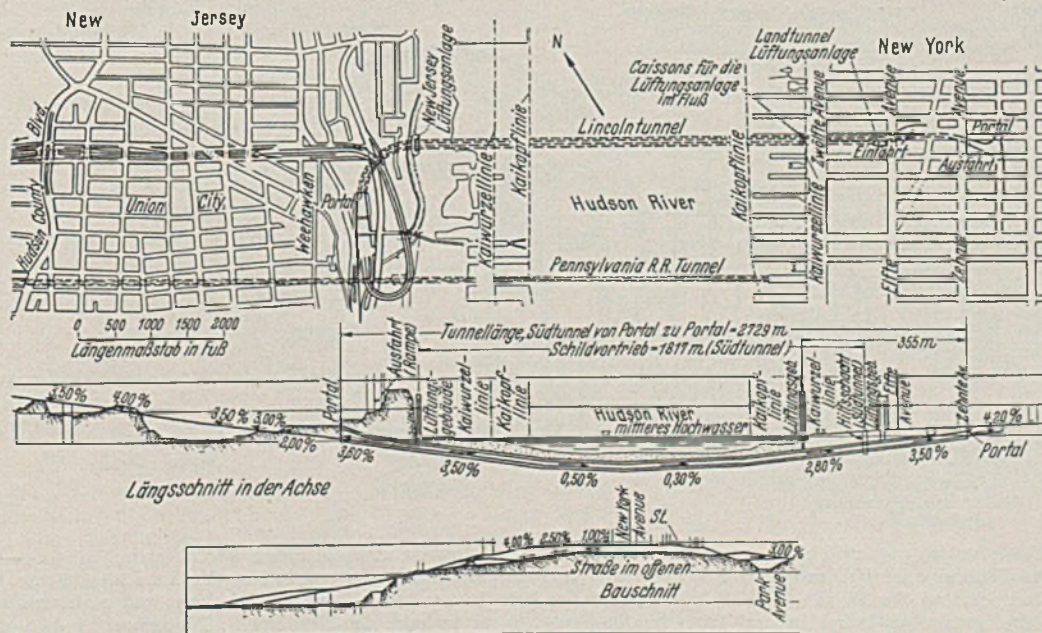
Lageplan und Längsschnitt des Lincoln-Tunnels.
